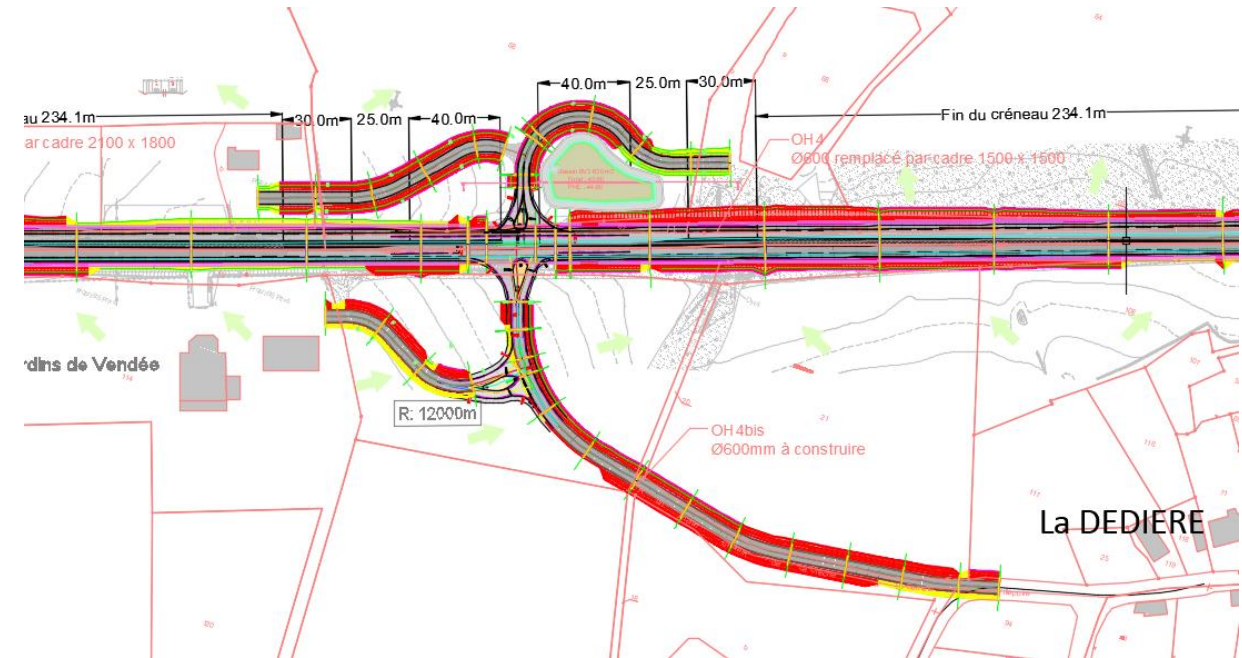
Plan du carrefour de la Dédrière - Section 1
